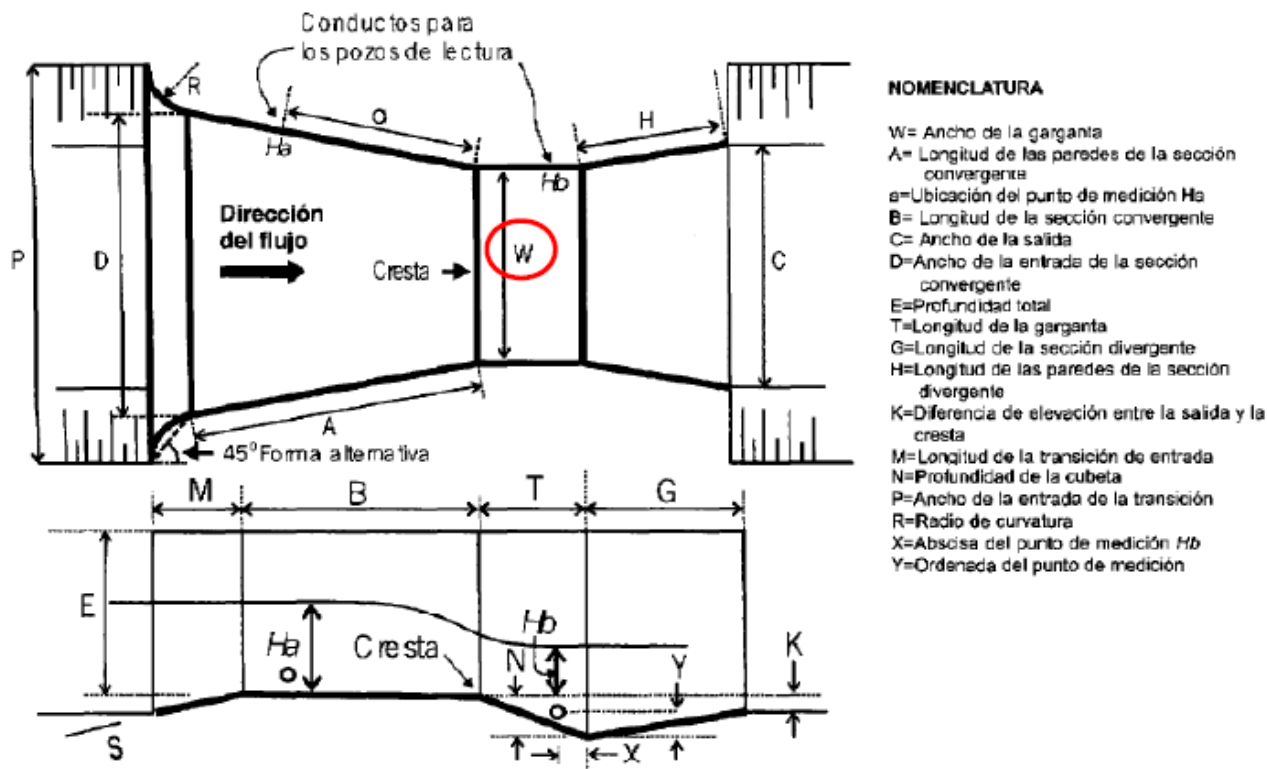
Vista en planta y perfil de un canal Parshall (Coello, 2016)
